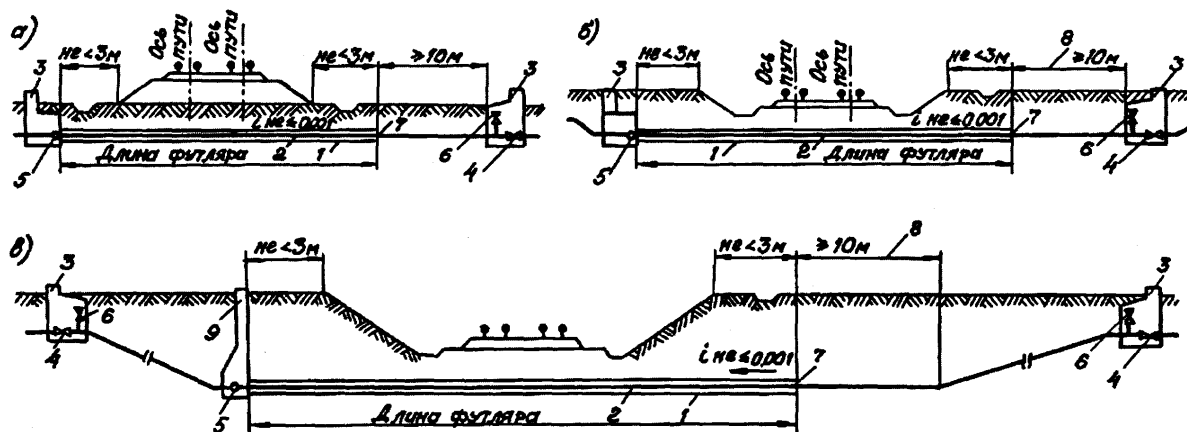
Схемы перехода водопроводами под железнодорожными путями: а - в насыпи; б - в неглубокой выемке; в - глубокой выемке; 1 – футляр; 2 – рабочий трубопровод; 3 – колодцы; 4 - задвижки; 5 - выпуск; 6 - вентиль; 7 - сальник; 8 - ремонтный участок; 9 - смотровой колодец
